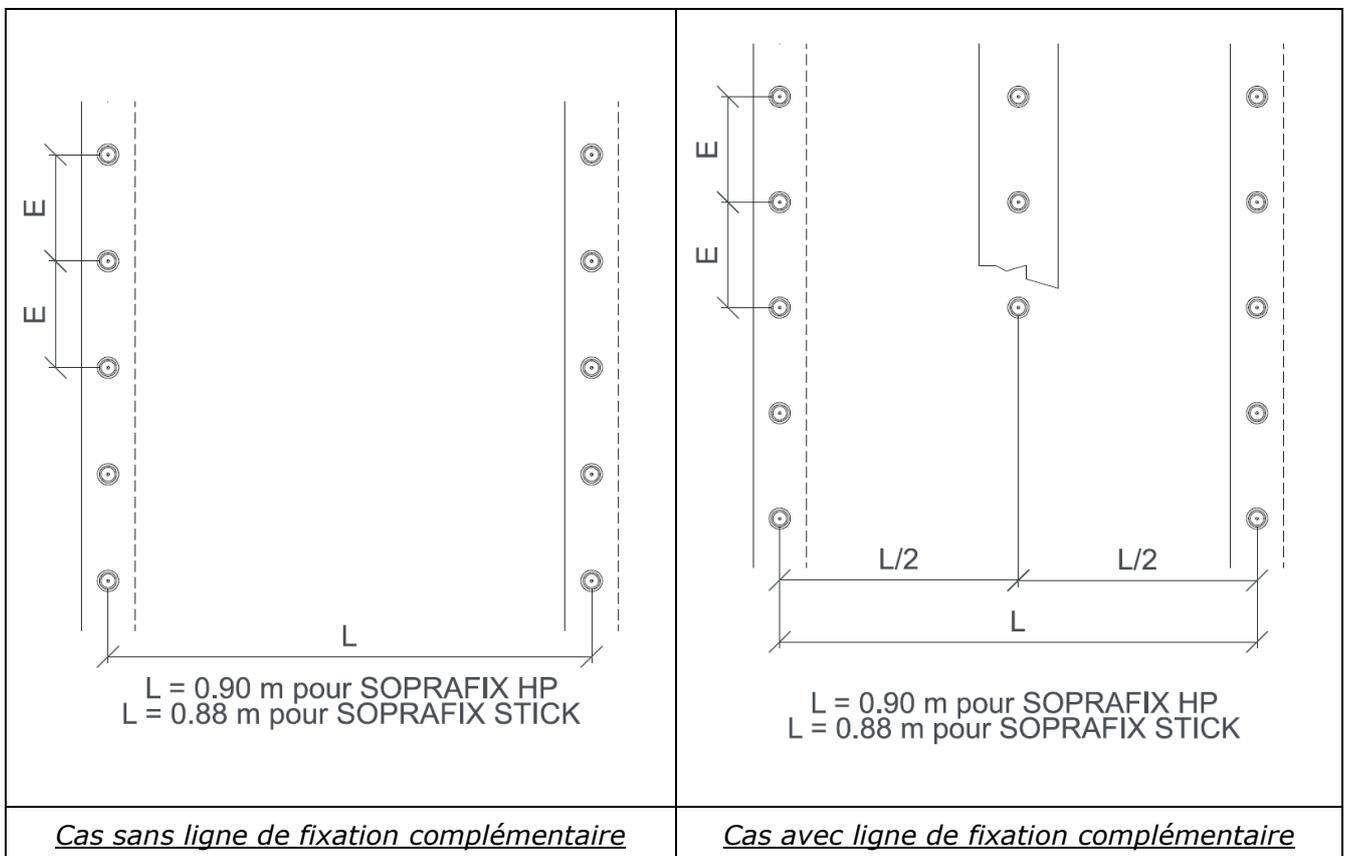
Disposition des fixations de la première couche d'étanchéité
